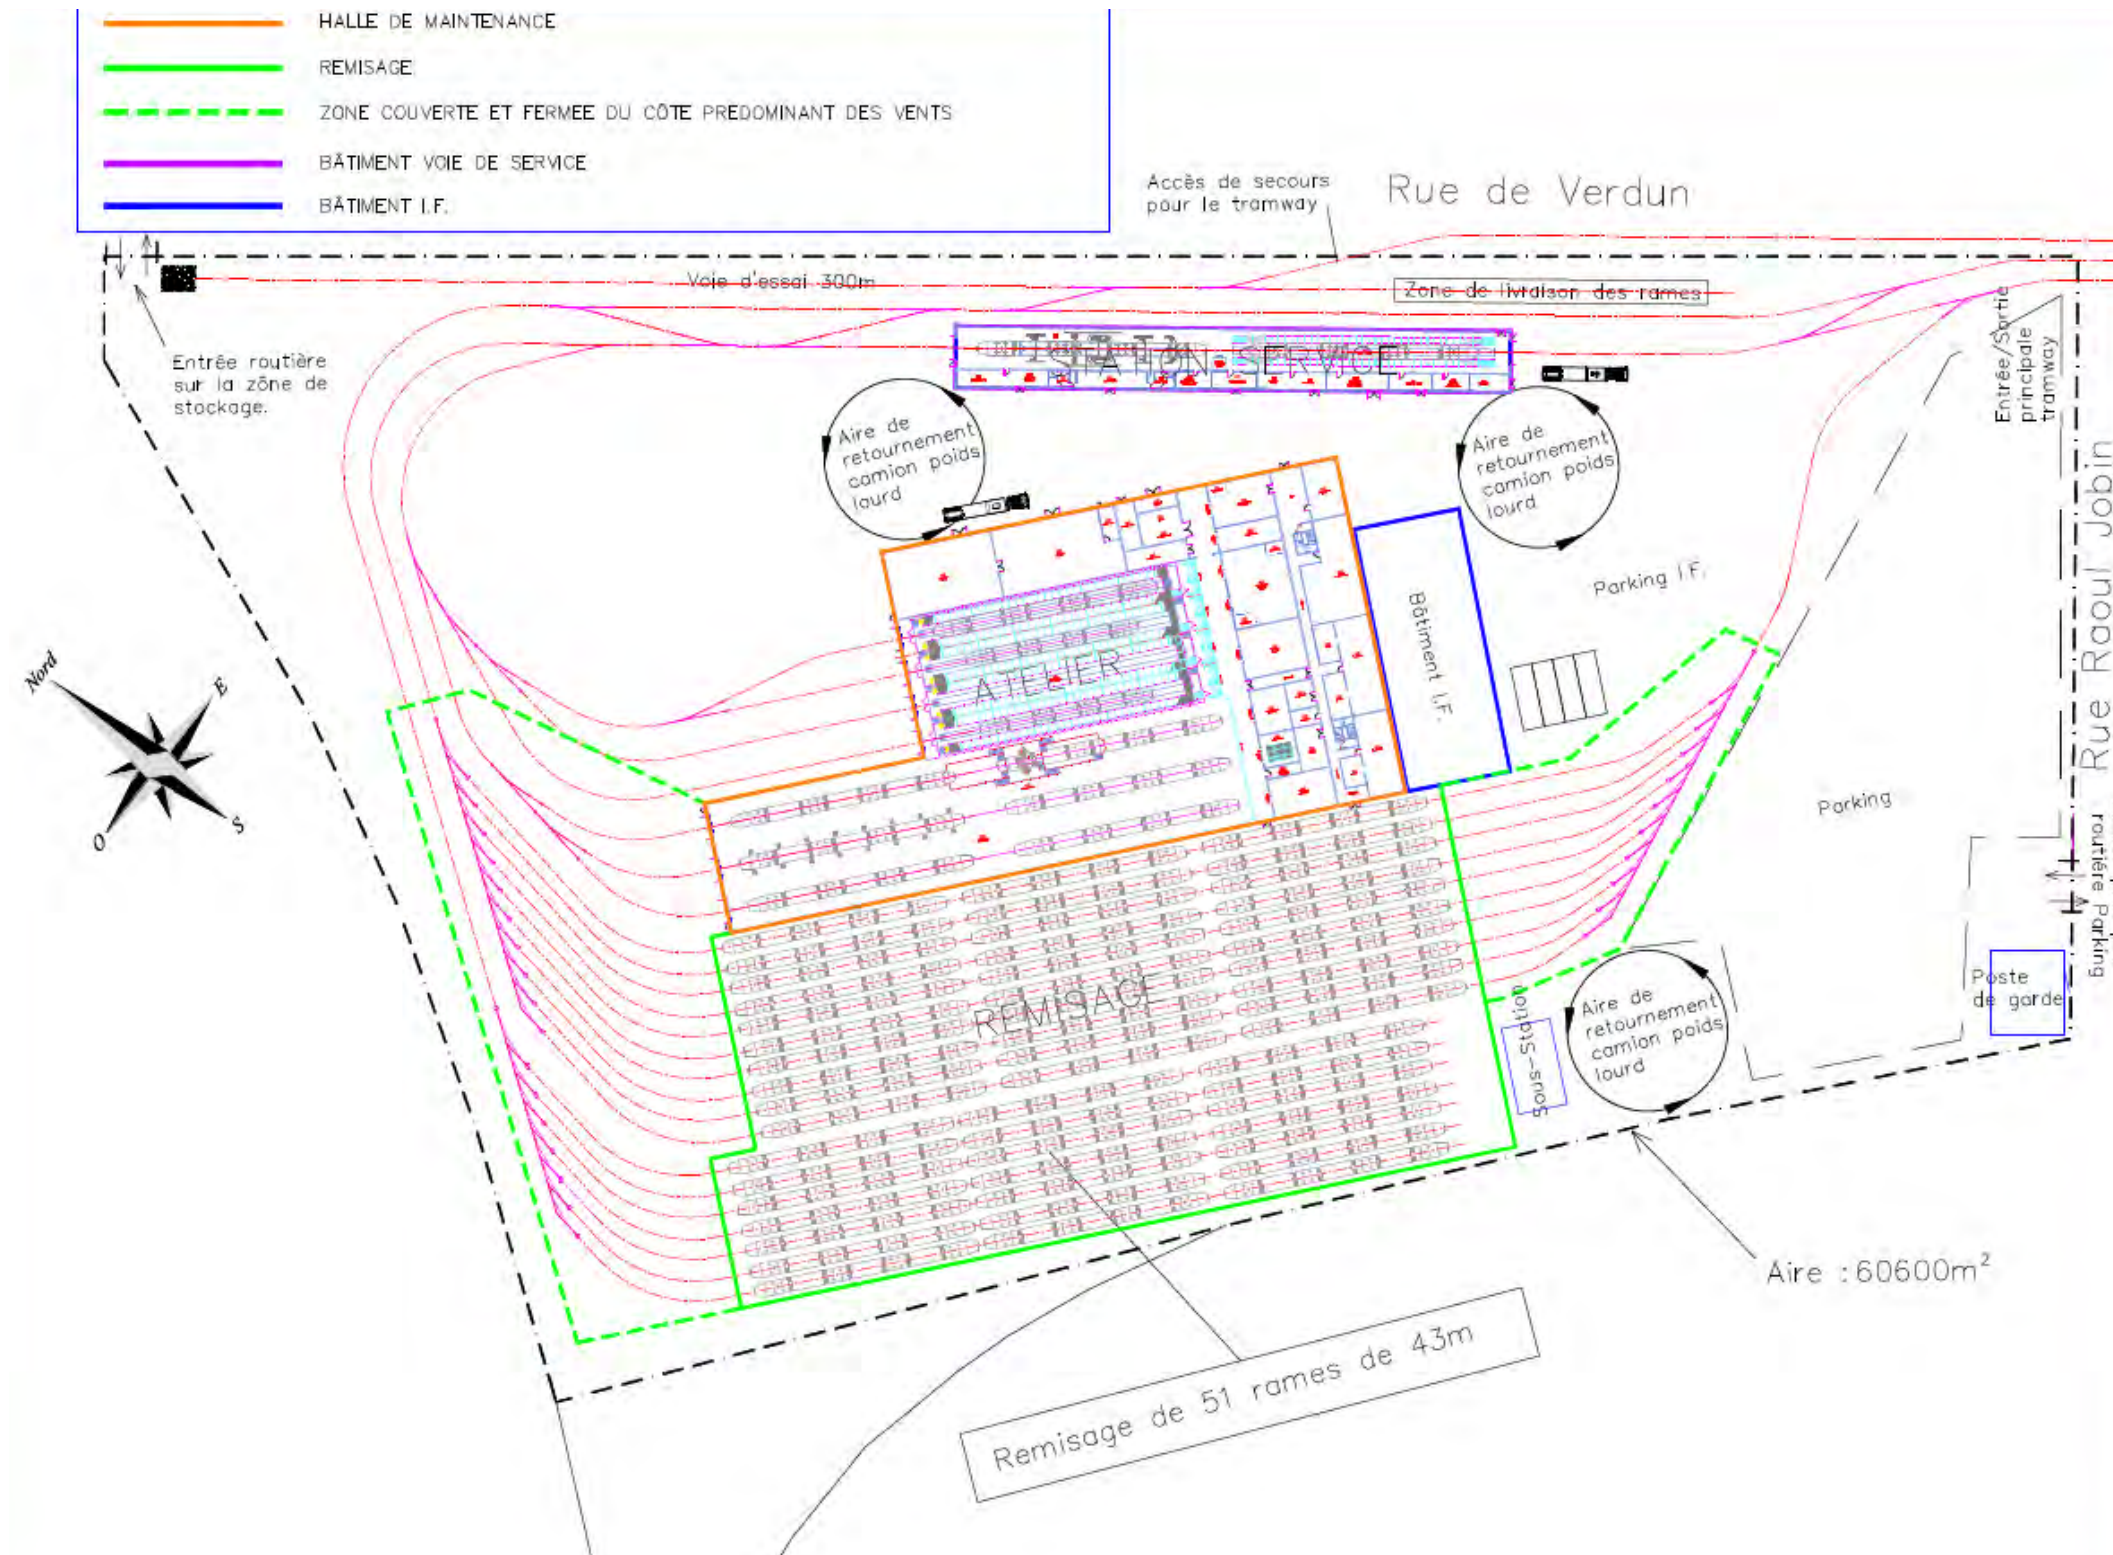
Plan masse du CEE Principal – rue de Verdun, Québec
